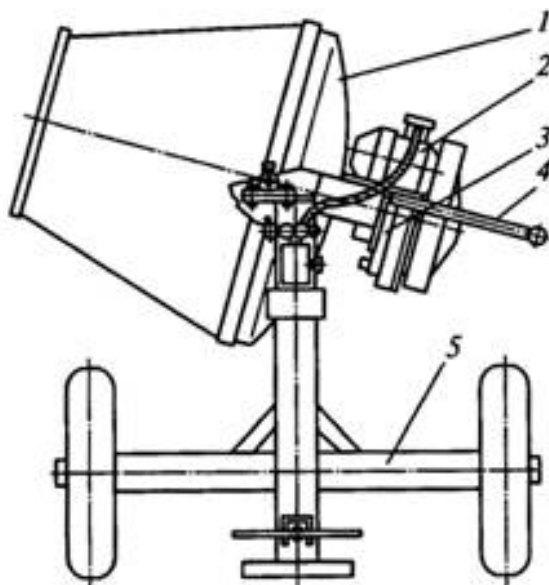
Передвижной малогабаритный растворосмеситель циклического действия: 1 – смесительный барабан; 2 – электродвигатель; 3 – редуктор; 4 – механизм поворота (наклона) барабана; 5 – рама с ходовой частью
